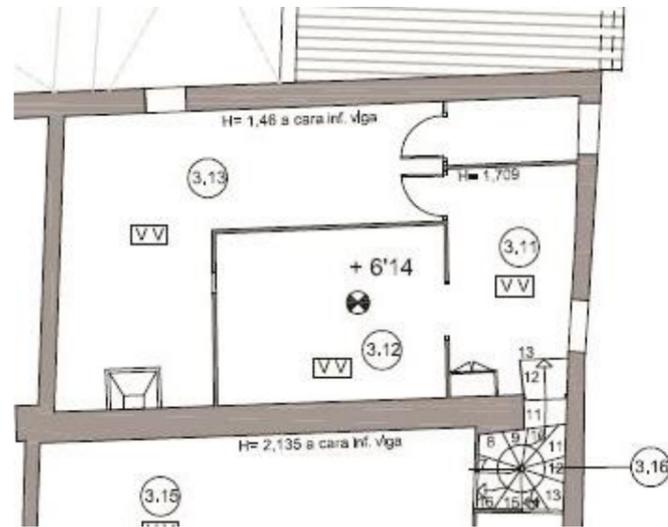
Planta cambrá 1º desembarco escalera caracol Fuente: Propia
